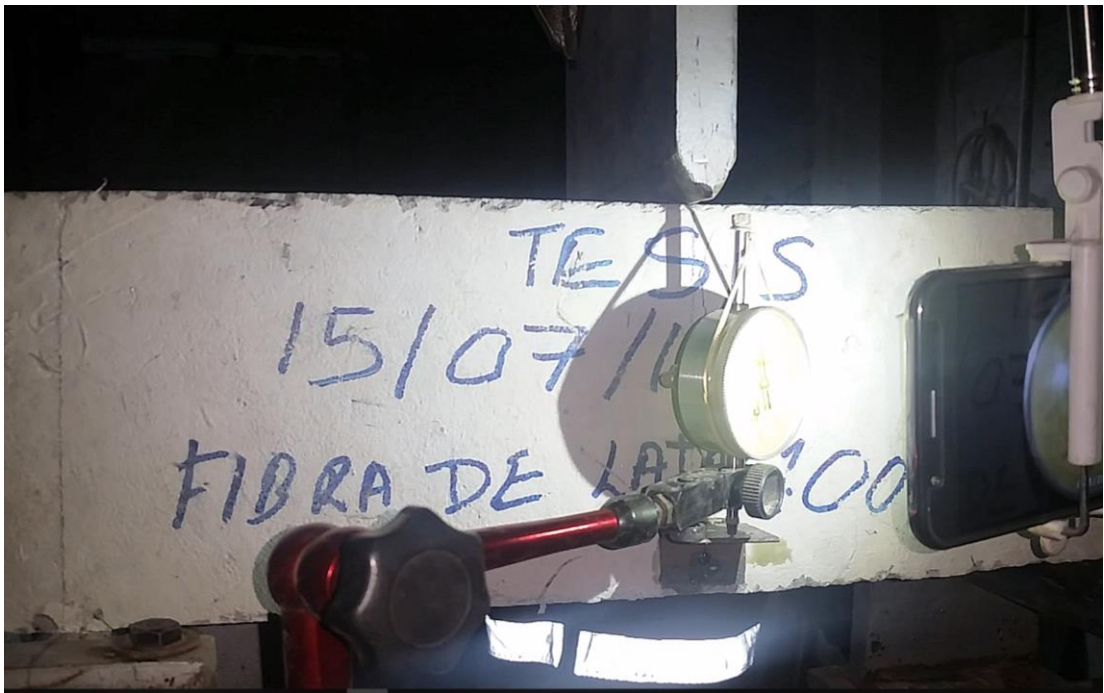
Rotura de probetas prismáticas con refuerzo de 25 kg/m<sup>3</sup> de fibra de acero
